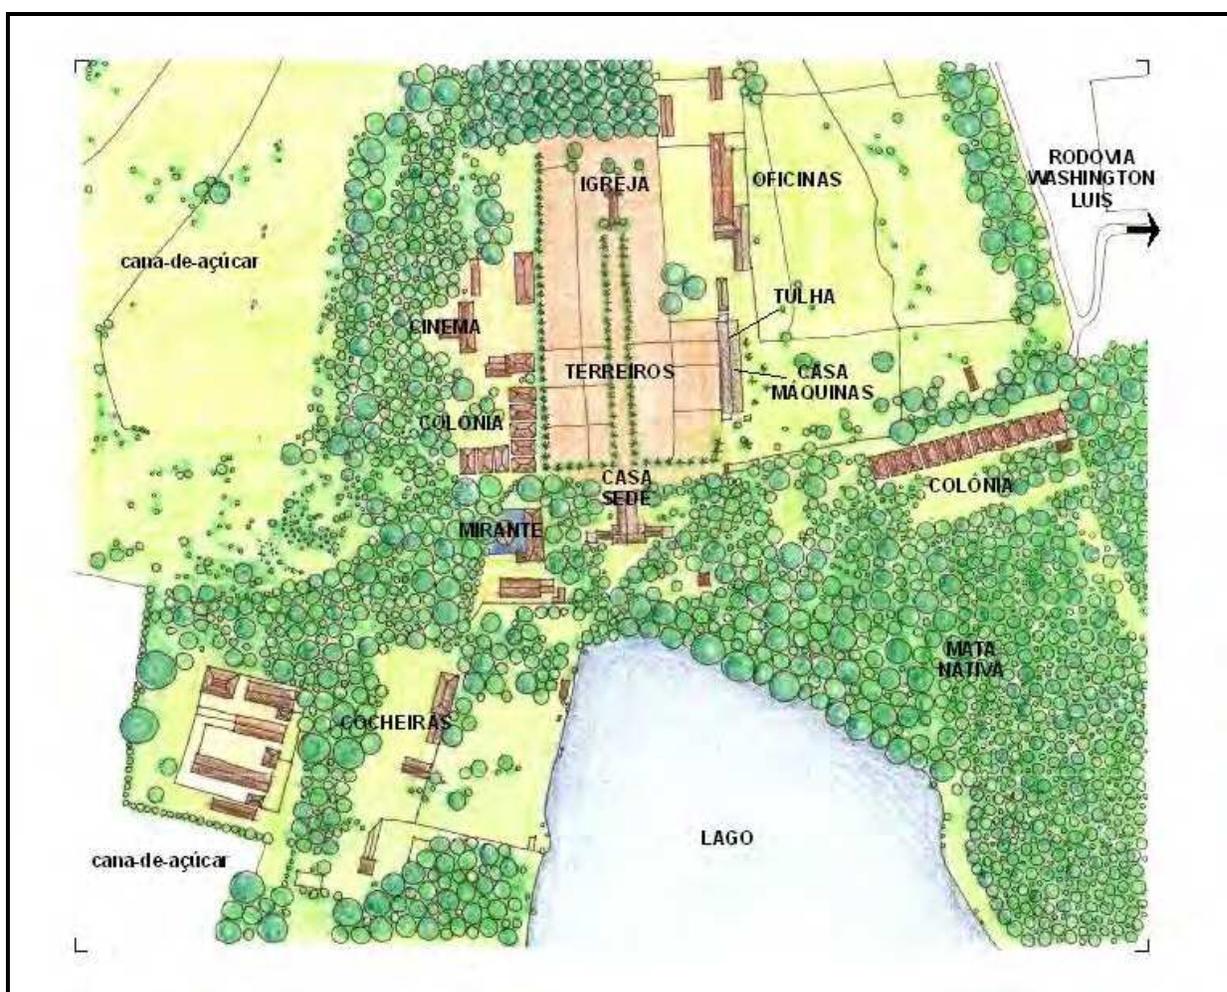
Croqui da implantação da Fazenda Santa Gertrudes.
